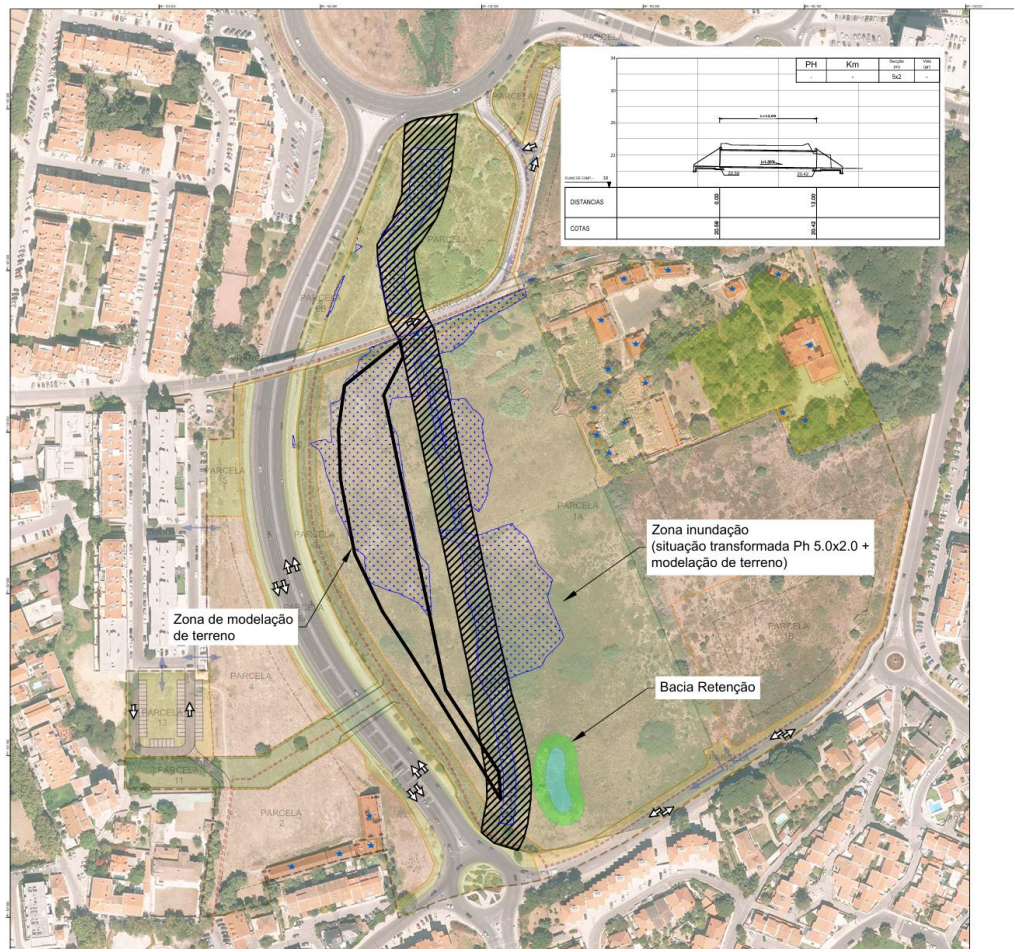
Área de inundação situação após introdução de passagem hidráulica complementar para a zona abrangida do plano e identificação de zona de modelação
